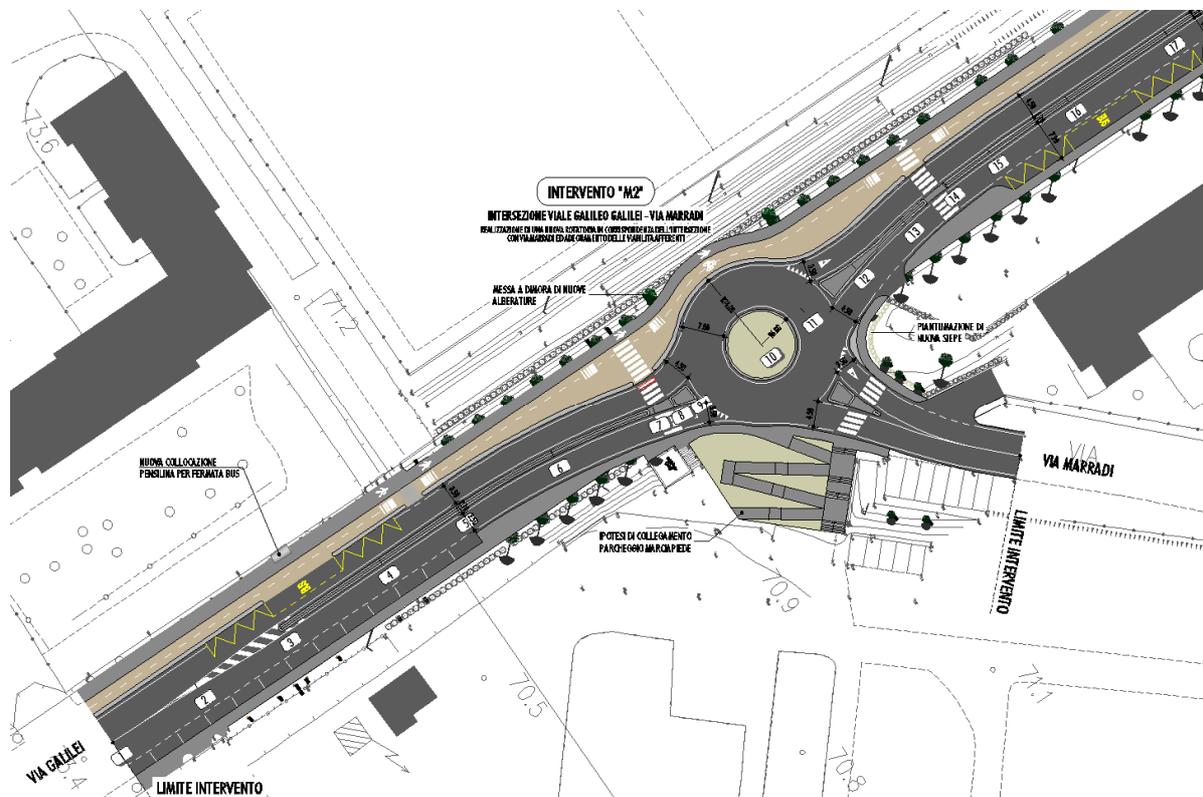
Intervento M2 – Rotatoria viale Galilei – via Marradi - stralcio planimetrico di progetto
